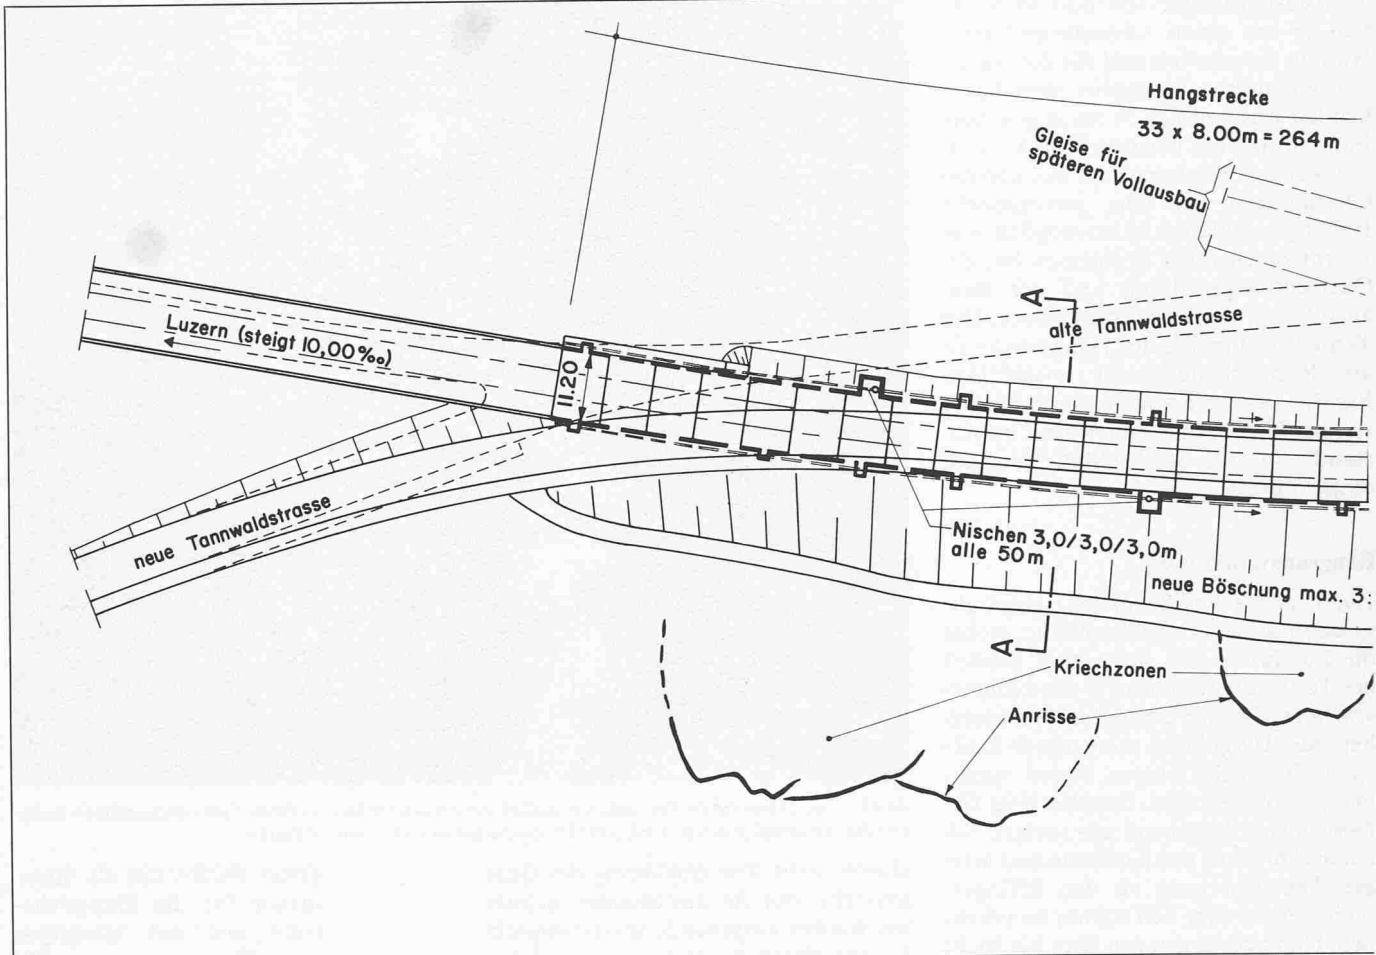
Übersicht Überwerfungsbauwerk Nord und Tannwaldtunnel mit Schema Entwässerungsanlage
